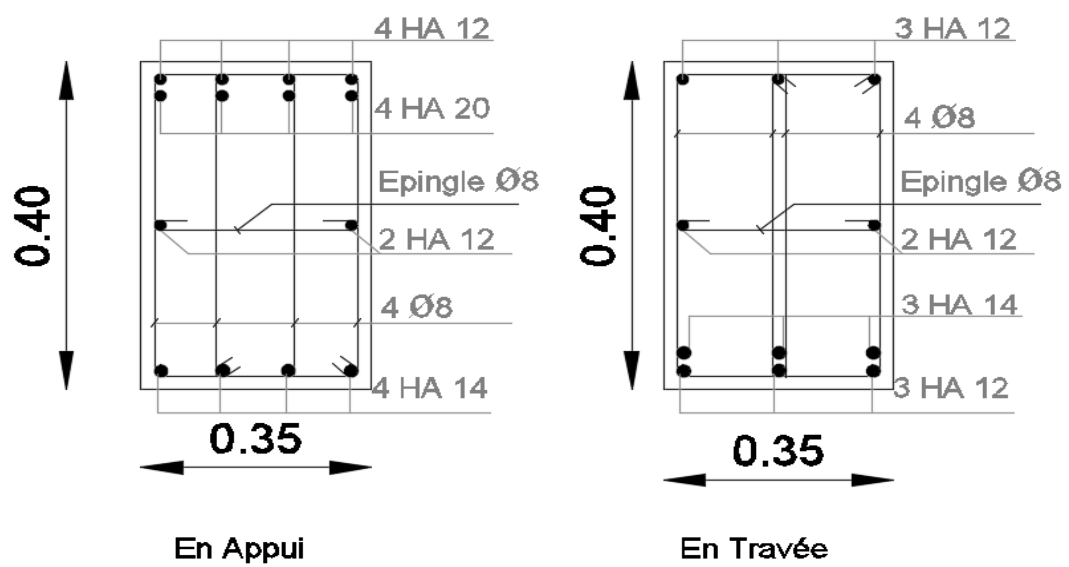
Ferrailage de la poutre secondaire (35x40)
